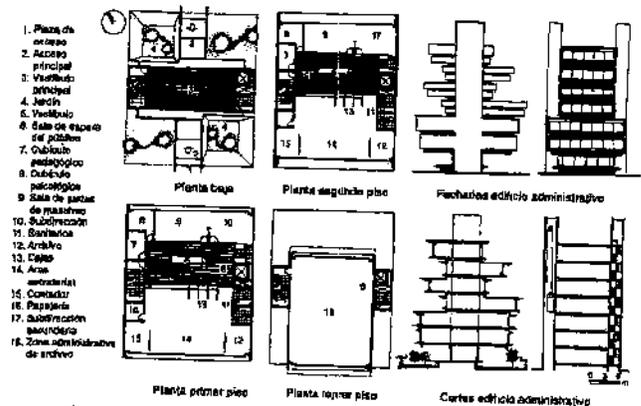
Planta Arquitectónica: Fuente (Plazola Cisneros, 1999)
